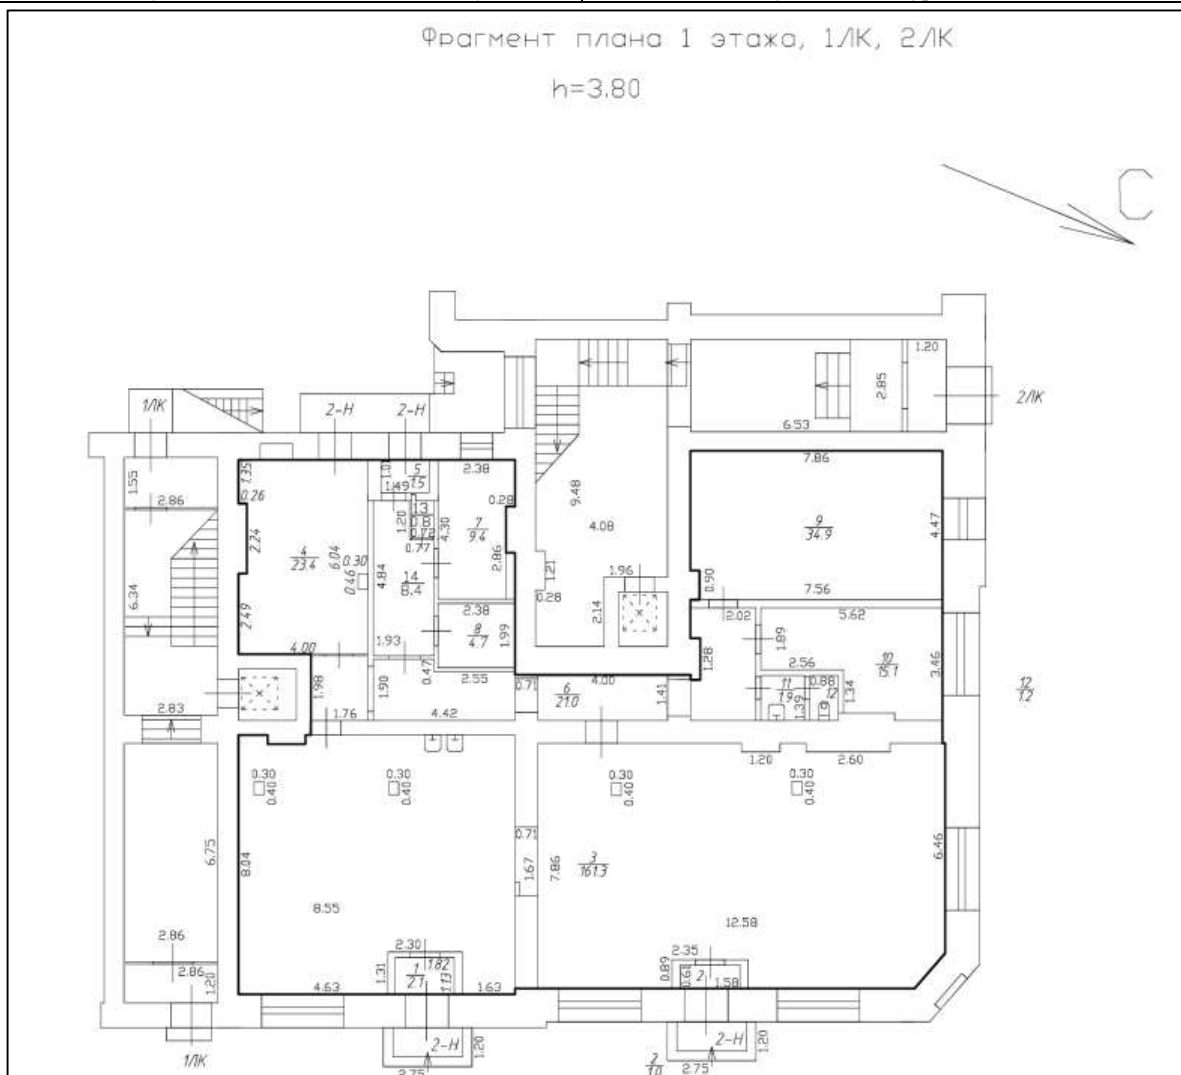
Расположение оцениваемого нежилого помещения на плане
